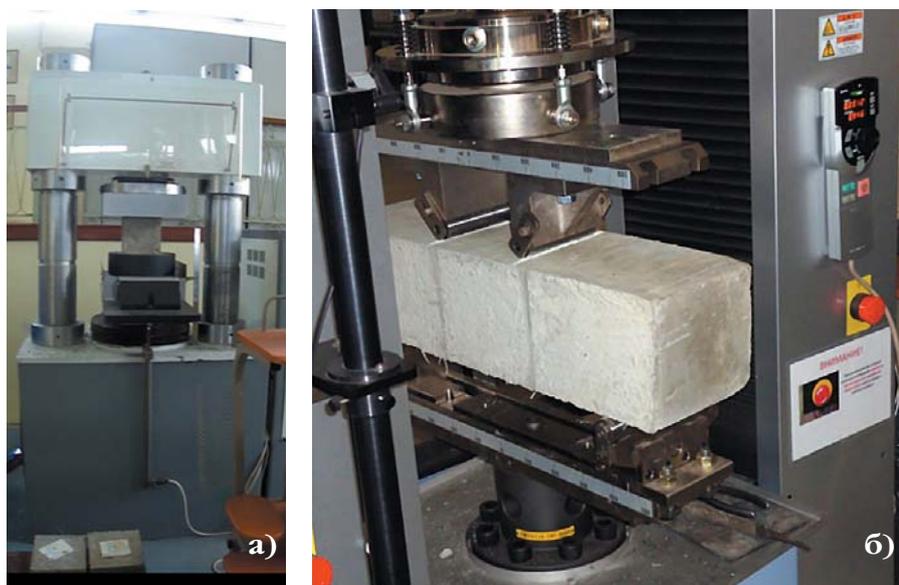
Испытание бетонных кубов на сжатие (а) и балок – на четырехточечный изгиб (б)
